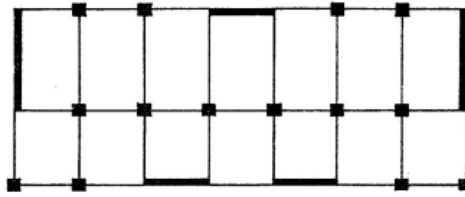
Perde sistem plan şeması (Yılmaz, 2006).
